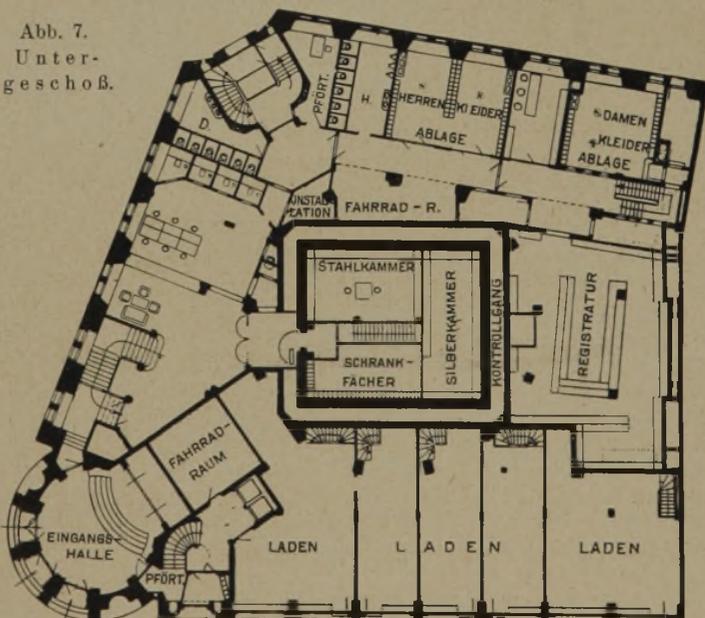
Grundrisse. Maßstab 1 : 500.
